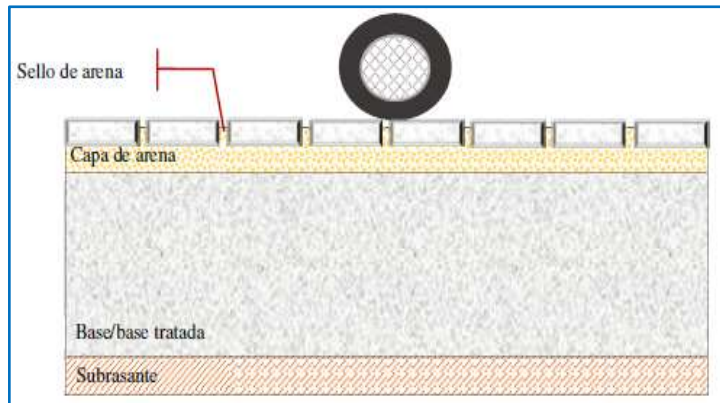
Estructura y distribución de cargas en pavimento semirrígido o adoquinado
